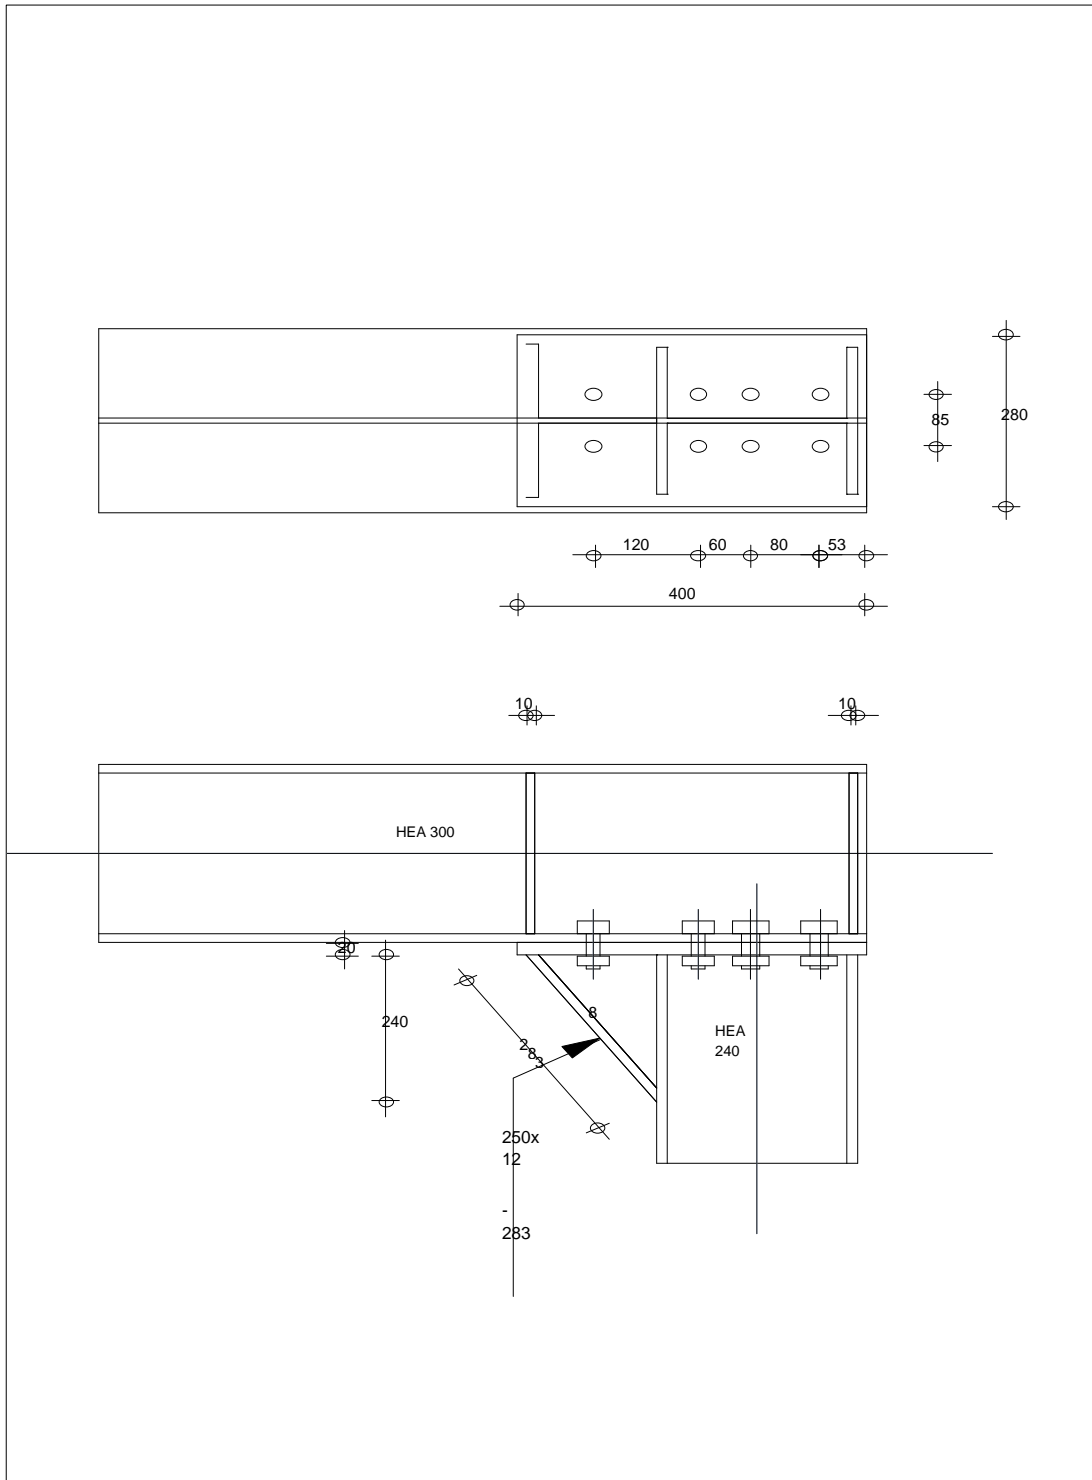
Schéma D'assemblage poteau-poutre principale.
